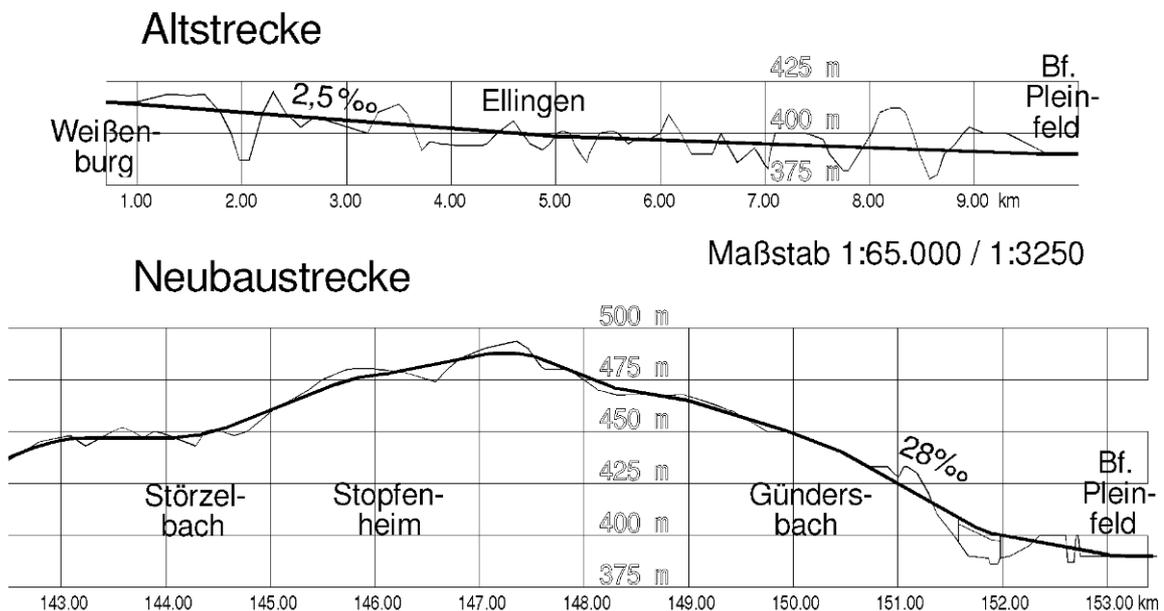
Neubaustrecke Donauwörth - Pleinfeld, nördlichster Abschnitt
